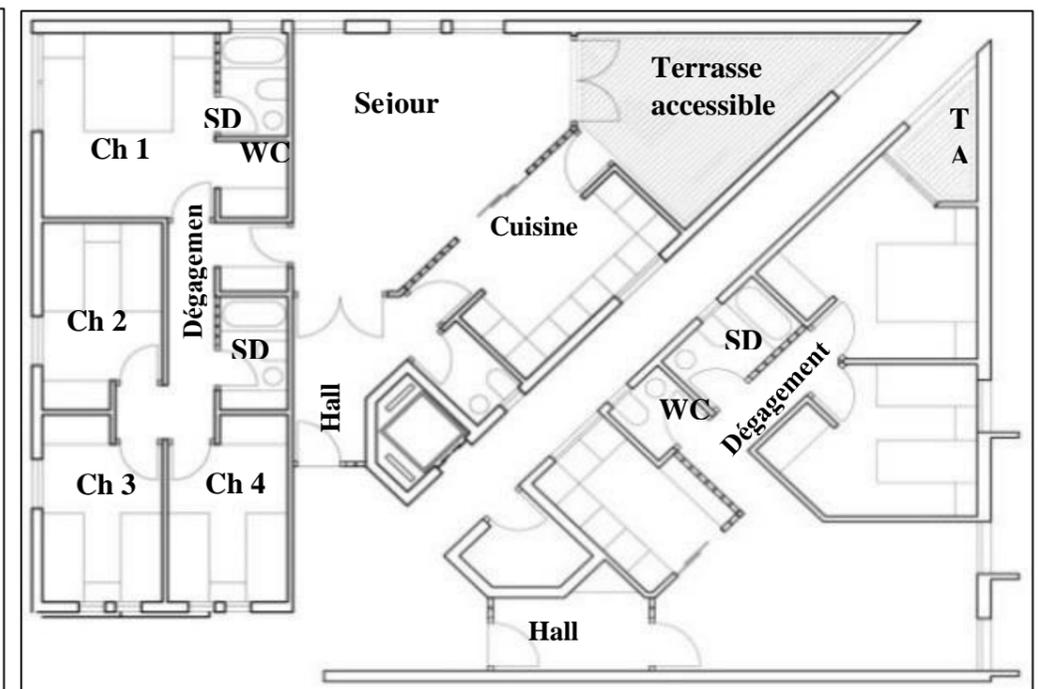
plan d'un appartement f5 + plan d'un appartement f3
